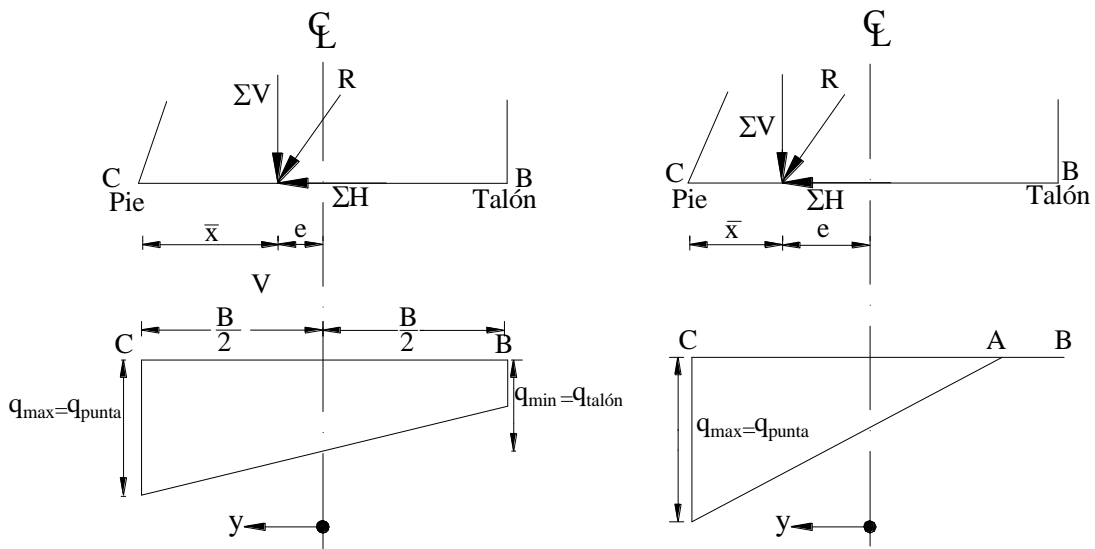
Distribución de la presión del terreno debajo de la losa de base de un muro de contención.
